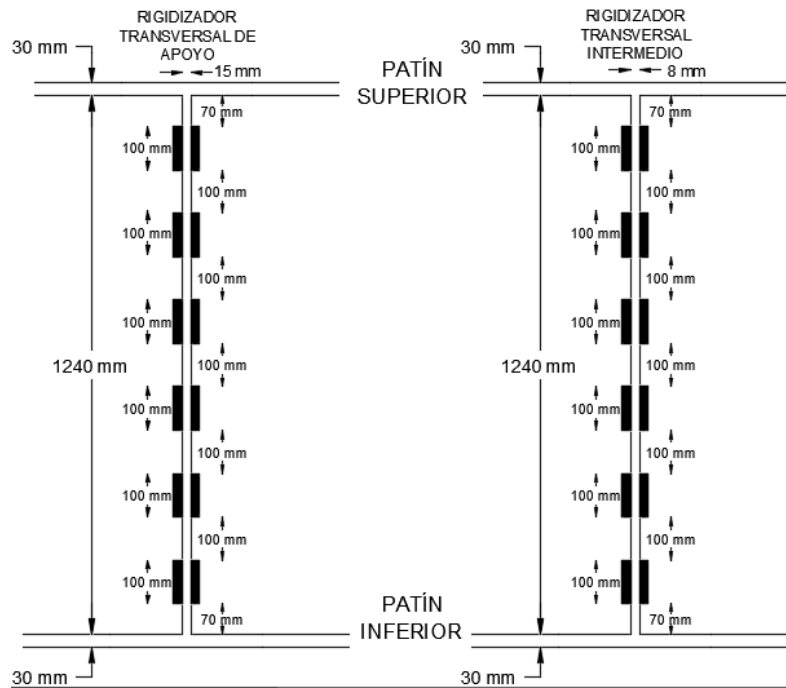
Cordón de soldadura entre el alma de la viga con el rigidizador transversal de apoyo e intermedio
